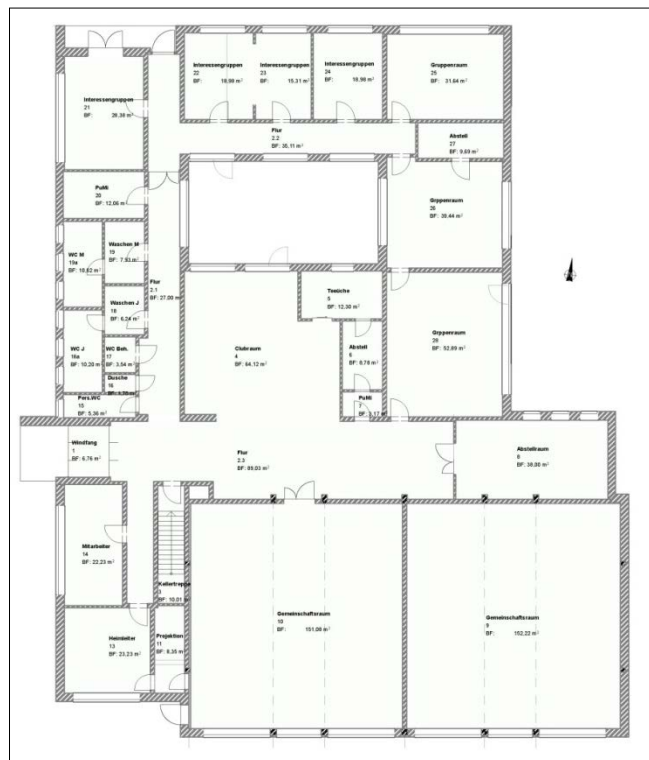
Grundriss Bestandsgebäude. Eigene Darstellung auf Grundlage des Grundrisses aus der Objektakte. Quelle: Bezirksamt Wandsbek
